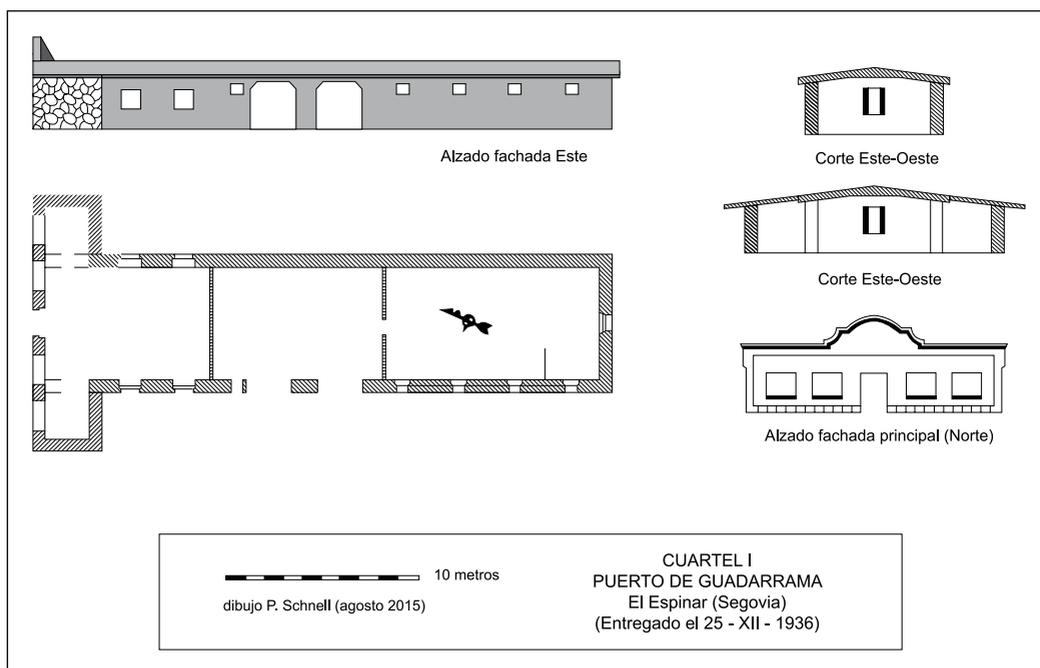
Planta, sección y alzado de uno de los cuarteles del puerto de Guadarrama. Las alas laterales y la fachada fueron añadidas a la obra inicial. Dibujo: Pablo Schnell Quiertant.
